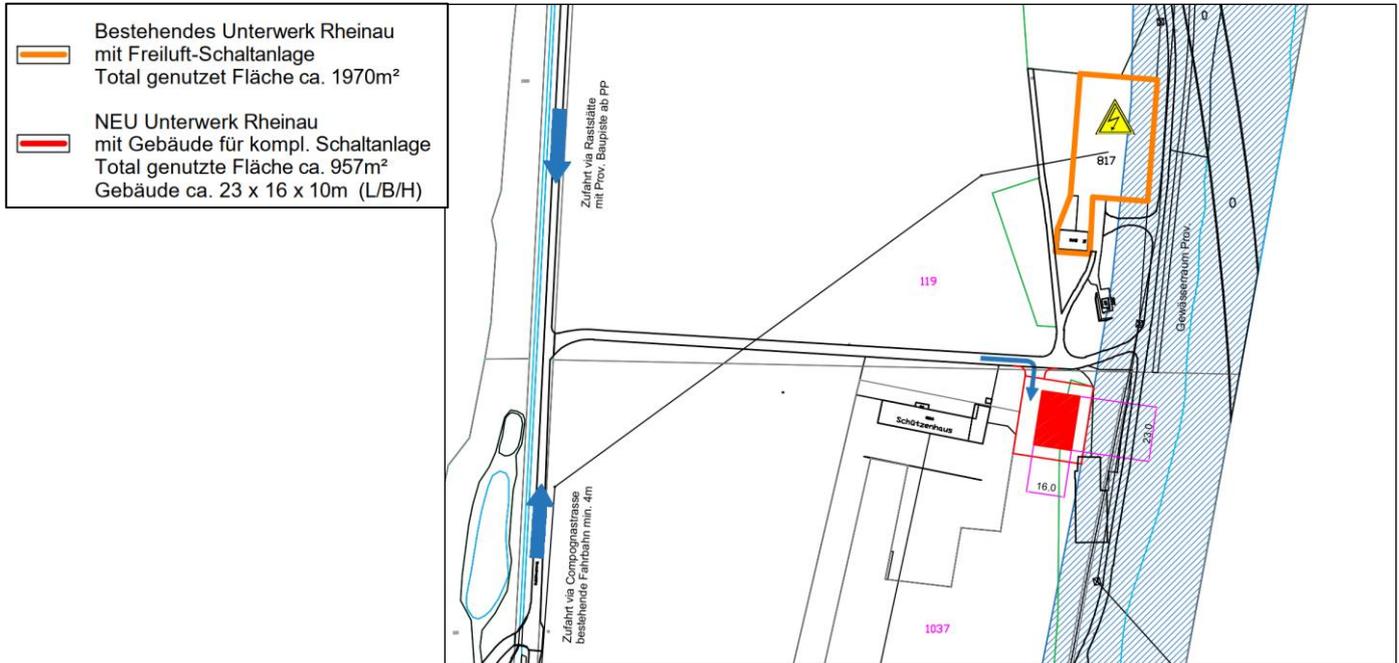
Kraftwerke Hinterrhein AG, Lageplan Ersatz Unterwerk Rheinau Thisis, 15. Januar 2025
